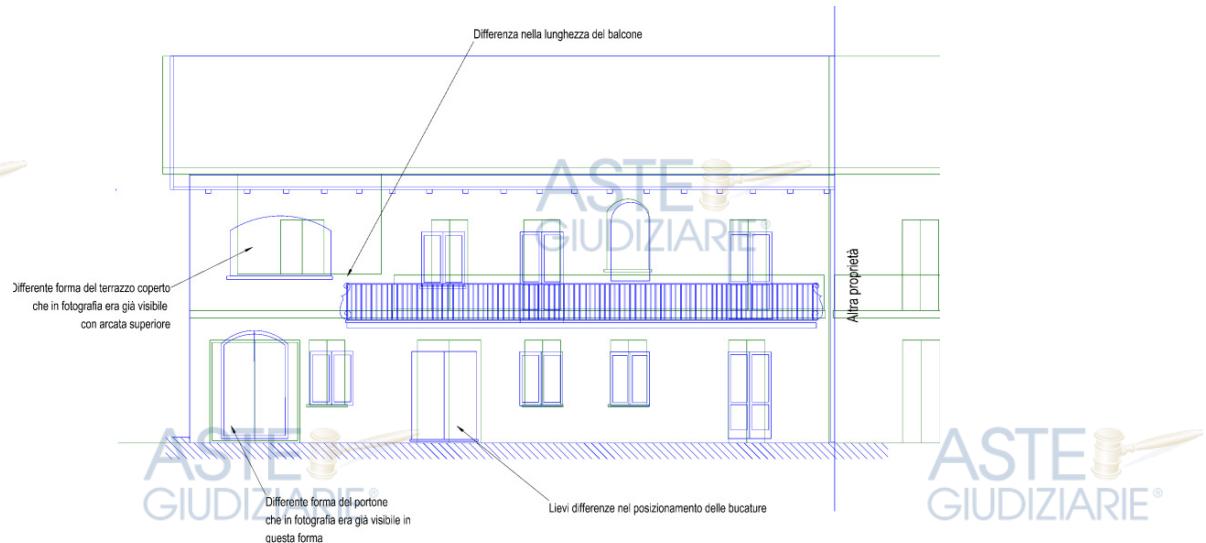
Estratto Tavola di Confronto fra rilievo stato di fatto e tavola di Conc. Sanatoria 1517/86 – Prospetto sud
